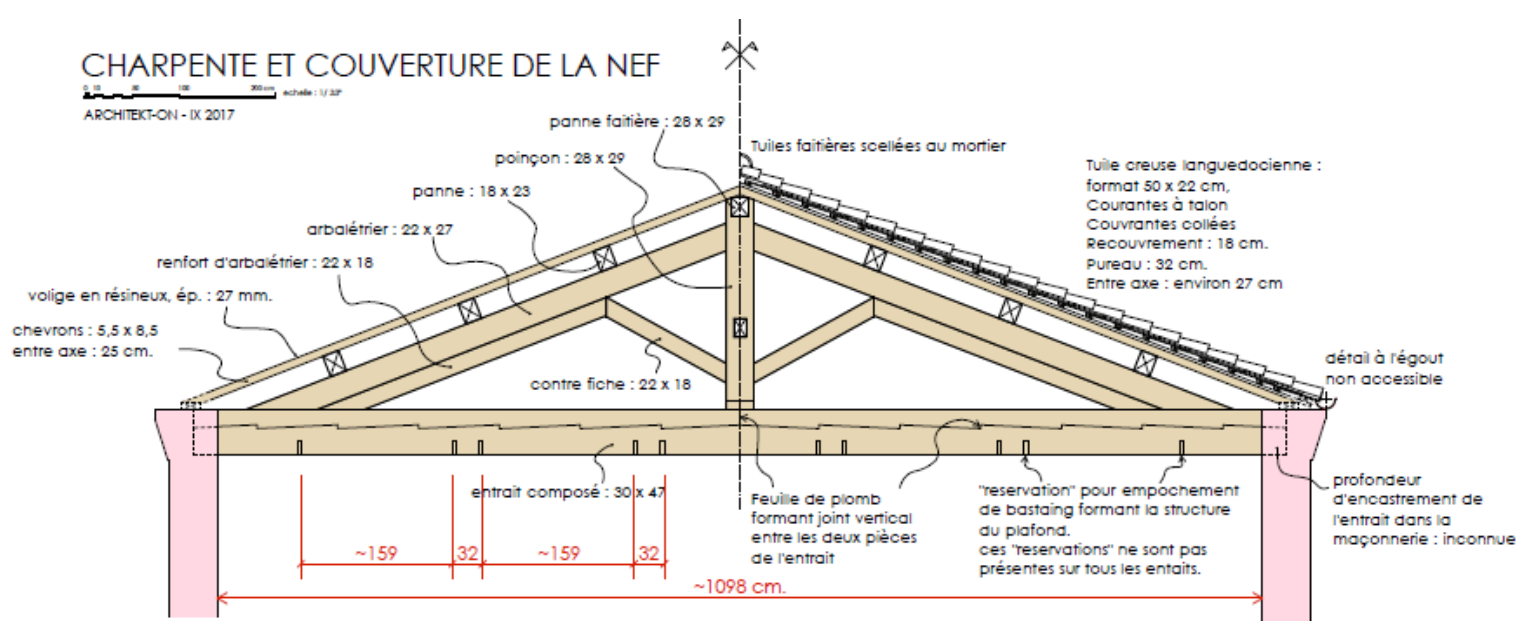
Description d'une ferme courante de la nef (extrait plan architecte)
